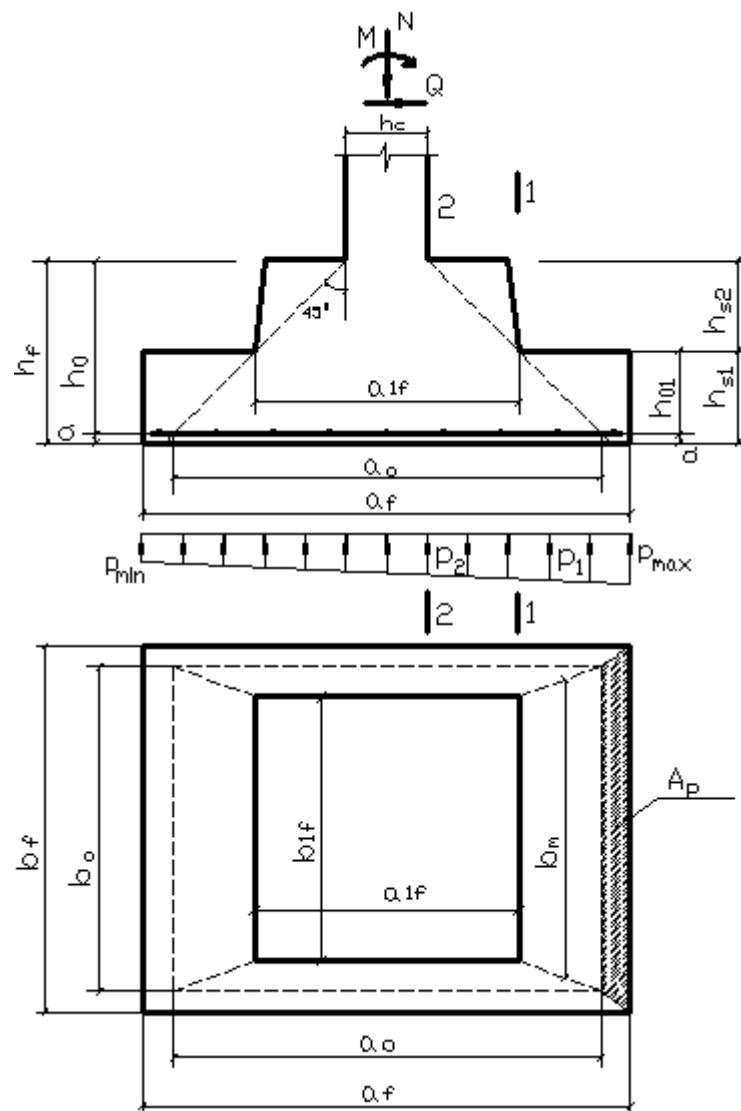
Схема к расчету по проверке высоты нижней ступени фундамента на продавливание
